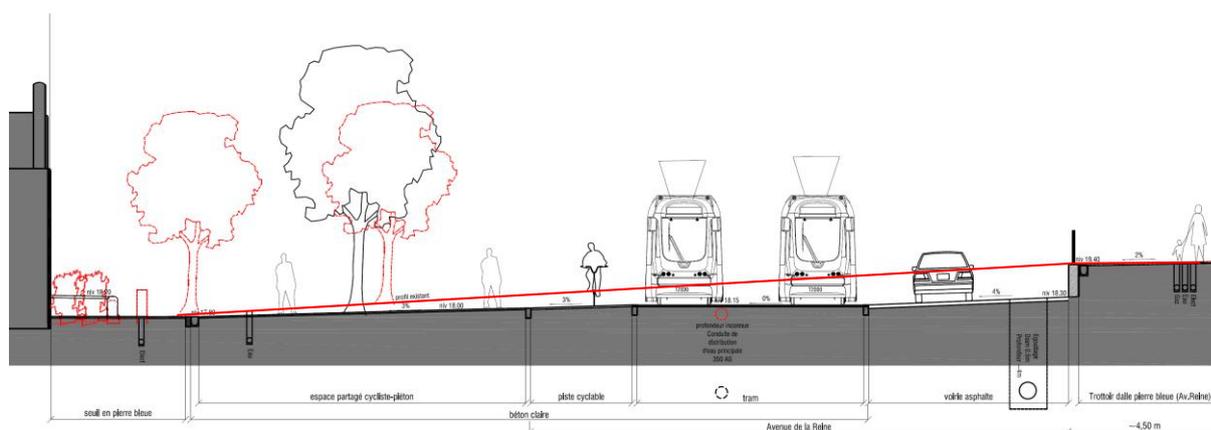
Coupe de principe au niveau du carrefour tunnel Thomas – avenue de la Reine
